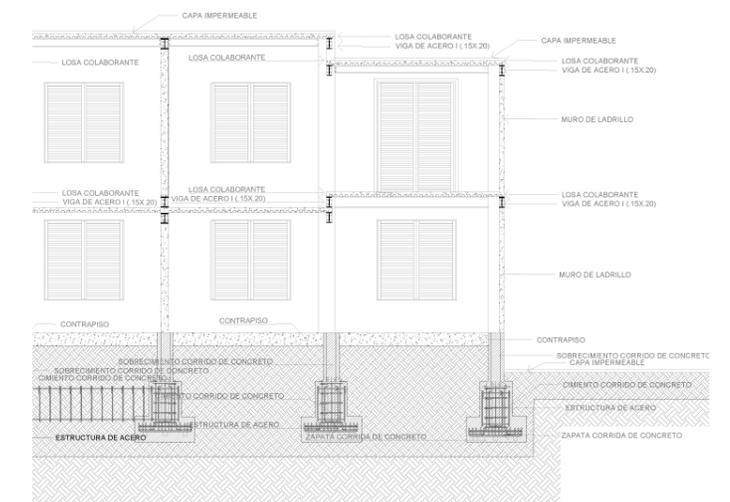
Ubicación referencial de zapatas, columnas, vigas y losas colaborantes por módulos en el proyecto
